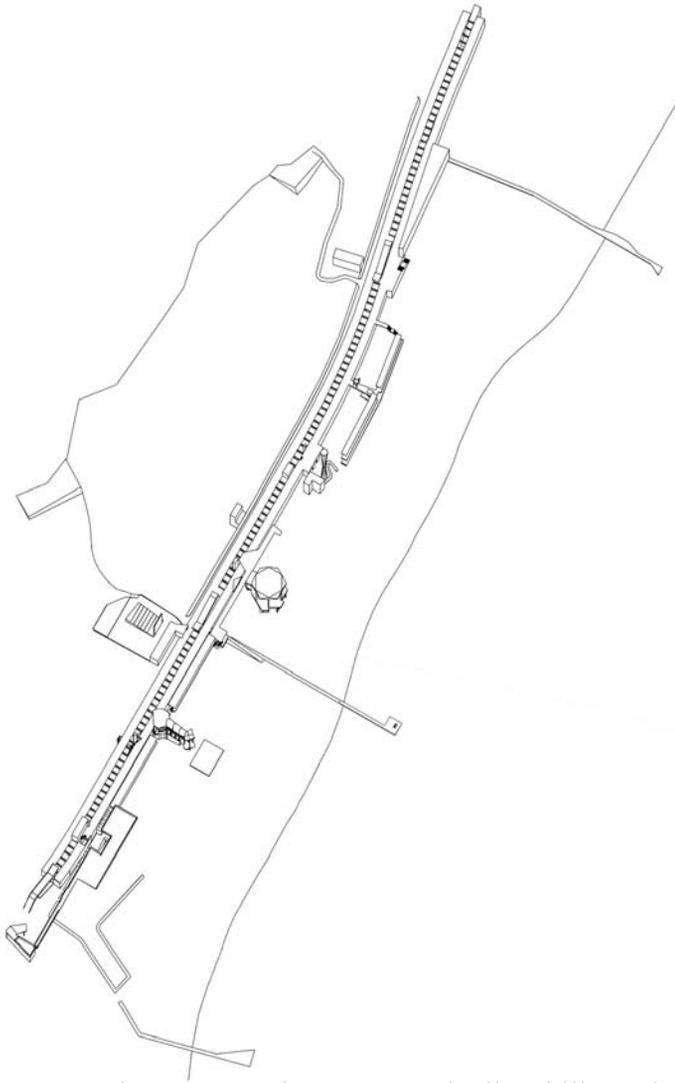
Progetto, pianta generale: quota spiaggia e sezioni
